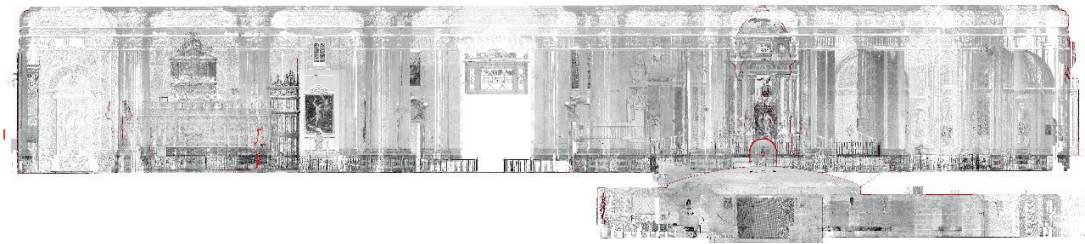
Sección longitudinal por la nave central mirando hacia el Oeste. Fuente: elaboración propia
